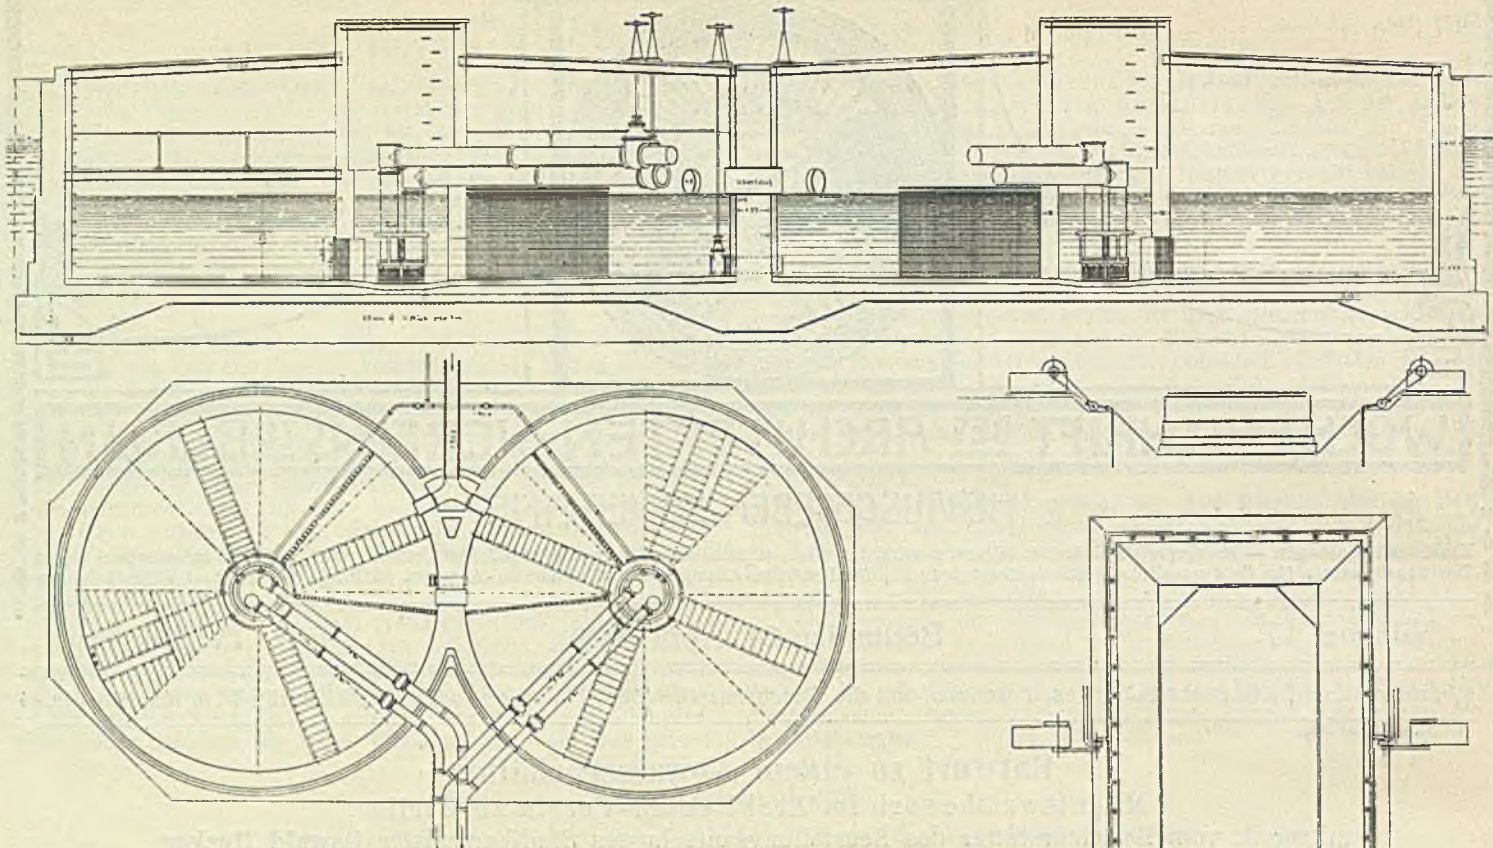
Abwasserbehälter: oben Längsschnitt, unten links Grundriß und unten rechts Grundwassersenkung
